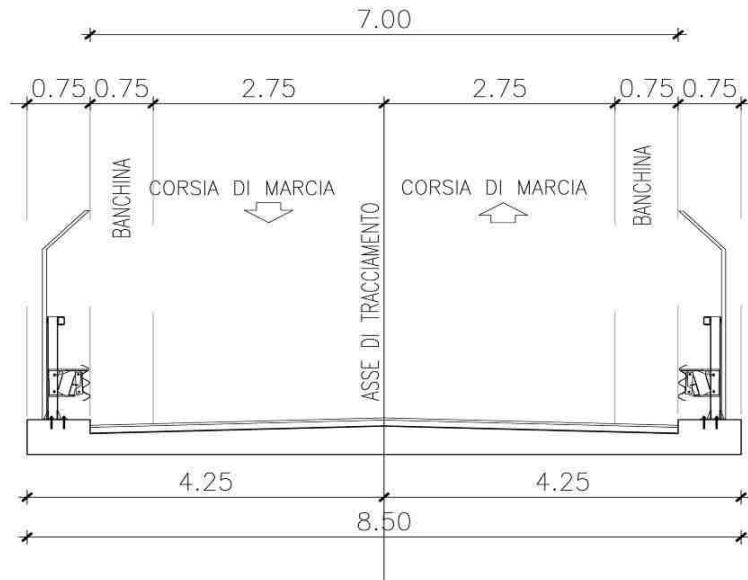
Sezione stradale Tipo “1” in sovrappasso
